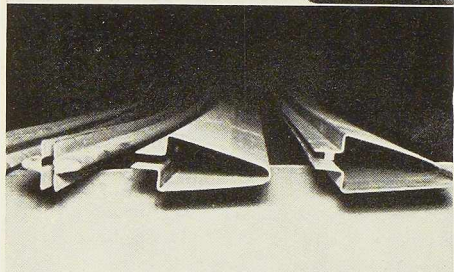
Poutre en tôle soudée, placée dans la partie chauffante du plancher et portant les tôles du plafond.
